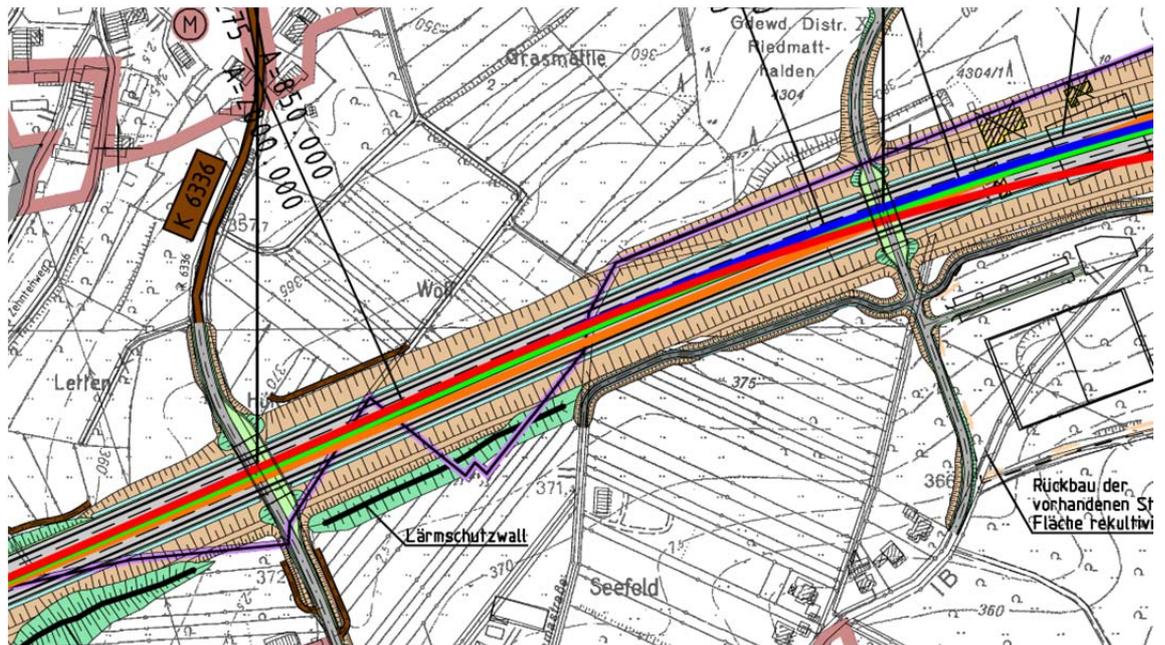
Ausschnitt aus Lageplan Variante 2 Unterlage 1.2 Blatt 2.1
